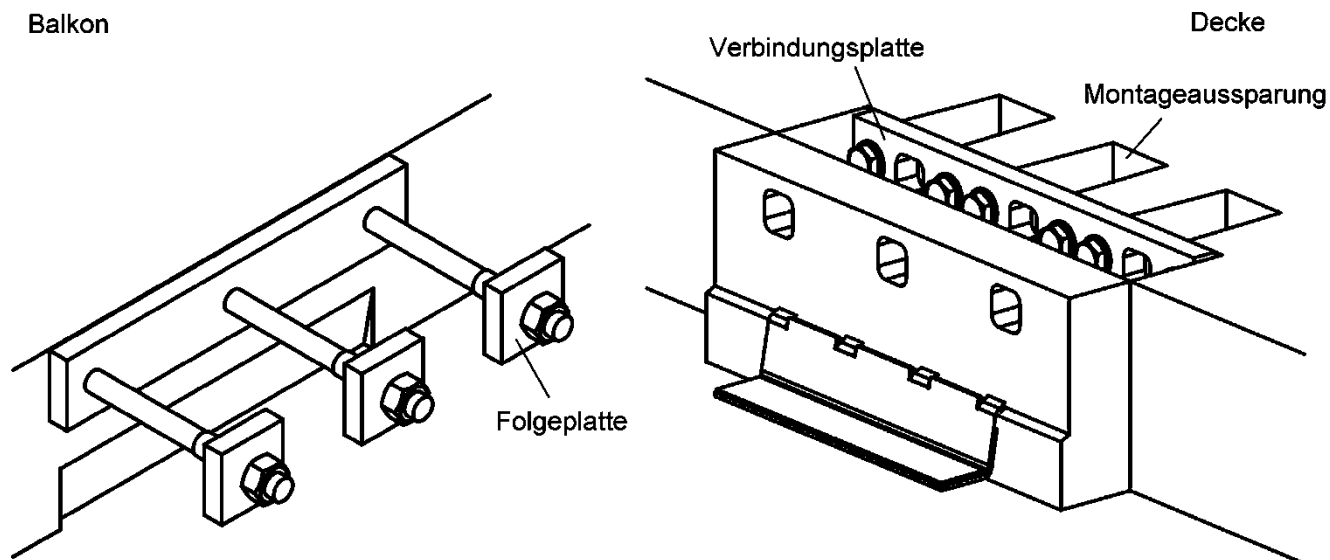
Isokorb® IQ-K-A: Zugstäbe balkonseitig einbetoniert, Schraubverbindung deckenseitig
